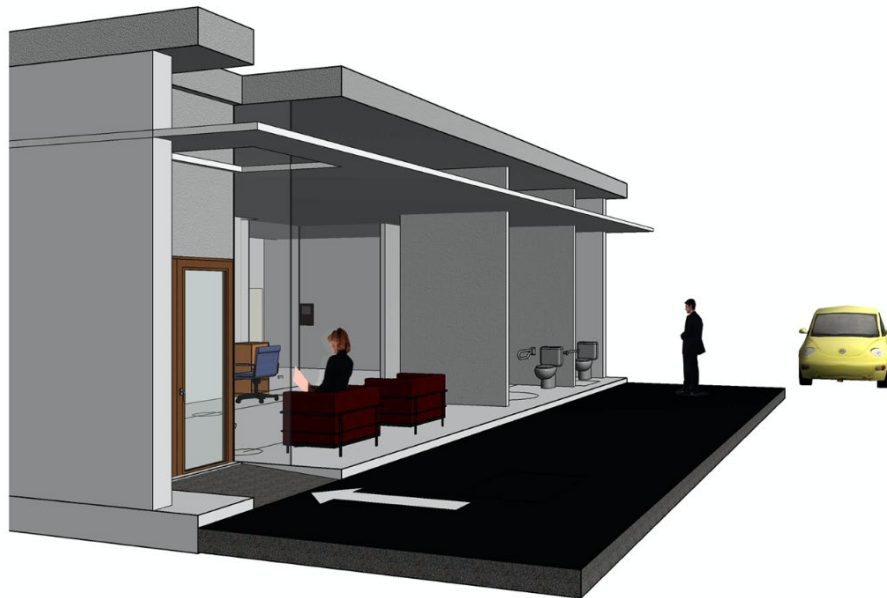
Foto planta reformada, fachada. Fuente: Propia y Revit®
